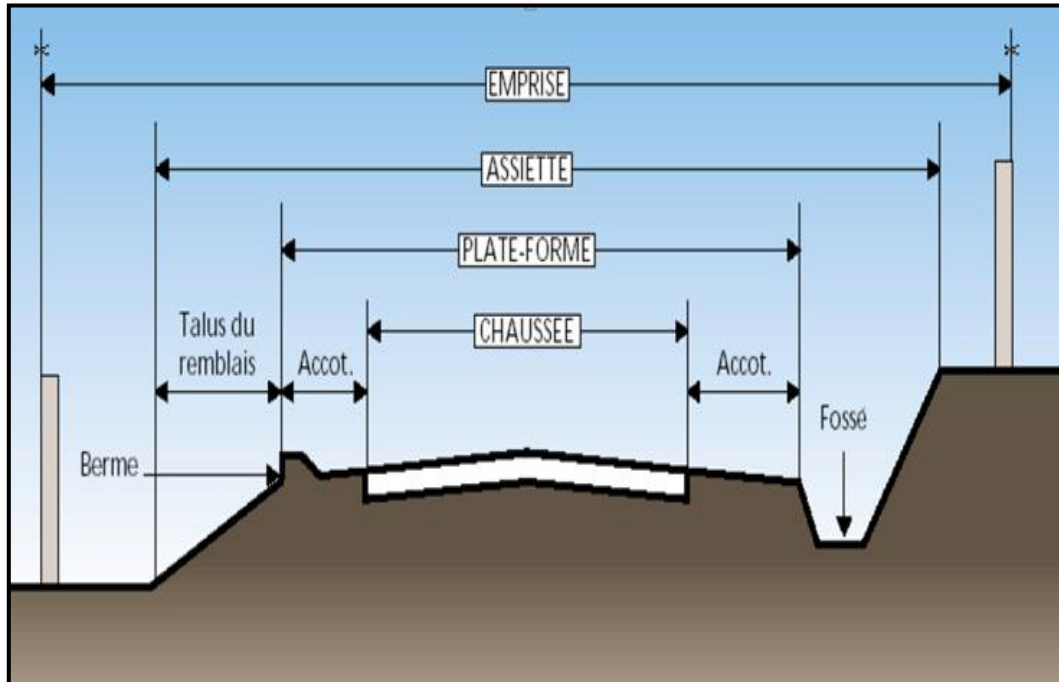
4:profil en travers d'une chaussée bidirectionnelle. [14]
